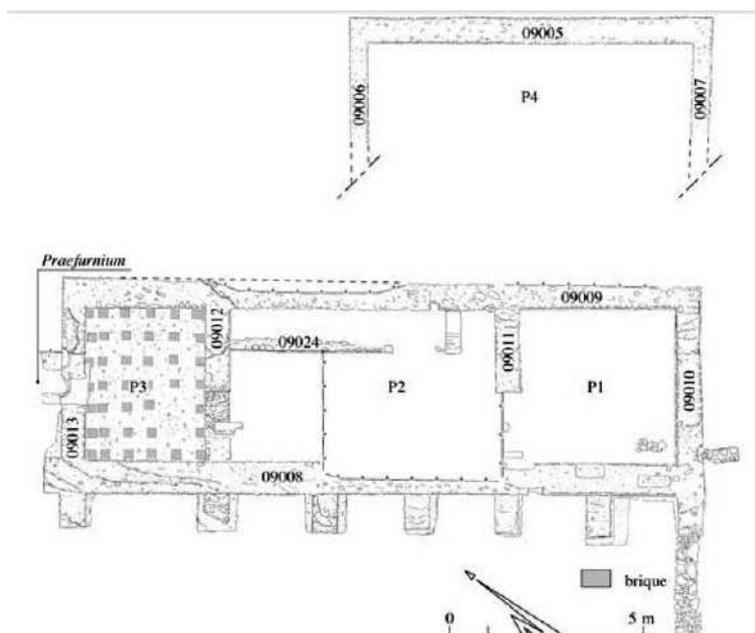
Planta de la Domus 1 de Labitolosa (Fincker et al., 2013c)
